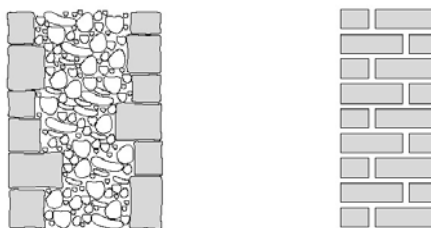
Tipos de secção transversal da alvenaria [21]
